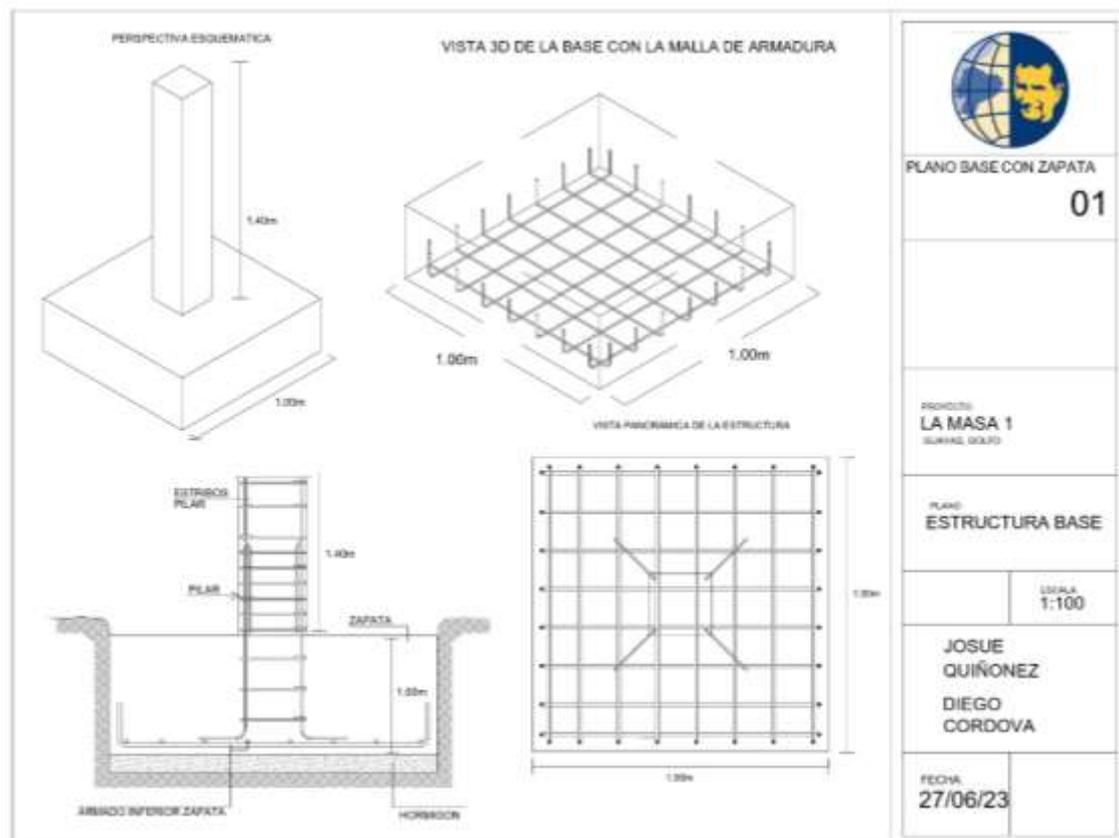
Plano en AutoCAD de la estructura de la base. Fuente: Los autores.
